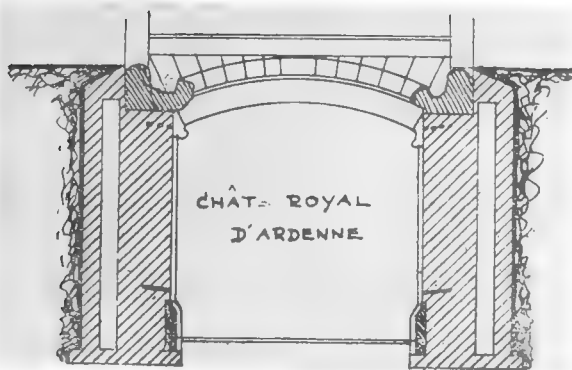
Coupe transversale sur les murs de ce passage montrant les contre-murs destinés à empêcher l'humidité.
